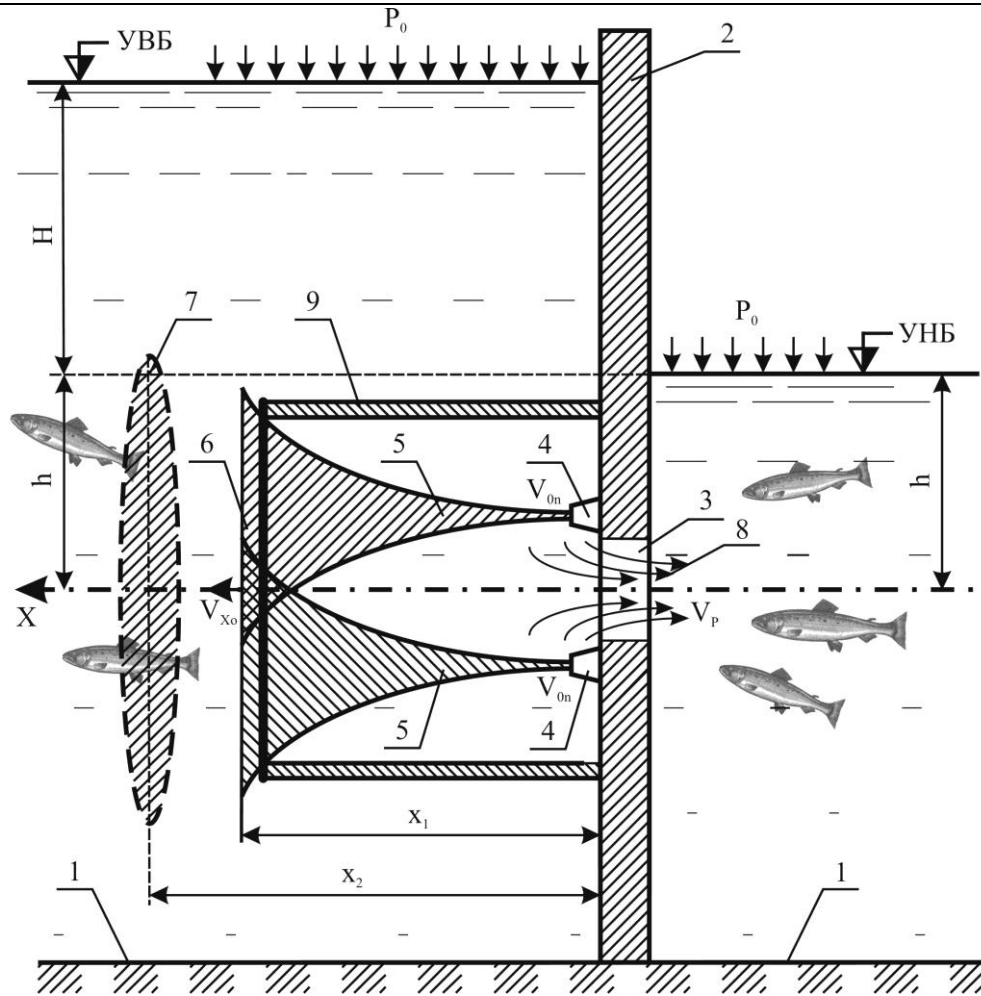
Схема создания зоны «частично равных давлений» для пропуска рыб, идущих на нерест, через ГТС: 1 – водосливной лоток (рыбоходный тракт); 2 – поперечная перегородка; 3 – рыбопропускное отверстие; 4 – струеобразующие насадки; 5 – ряды параллельных гидравлических струй; 6 – суммарный поток; 7 – зона «частично равных давлений»; 8 – привлекающий поток; 9 – заградительный козырек; УНБ – уровень нижнего бьефа; УВБ – уровень верхнего бьефа; P_0 – давление на свободной поверхности; H – величина напора со стороны верхнего бьефа; h – глубина погружения оси вливного отверстия; V_p – скорость привлекающего потока; V_{0n} – начальная скорость истечения гидравлических струй из насадок; V_{x0} – начальная осевая скорость суммарного потока; X – ось распространения суммарного потока; x_1 – расстояние от поперечной перегородки до зоны взаимодействия струй воды; x_2 – расстояние от поперечной перегородки до зоны «частично равных давлений»
